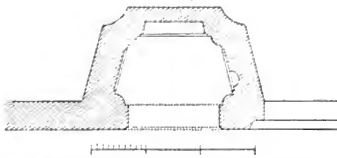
Malčany. Grundriss der Erkerkapelle.
